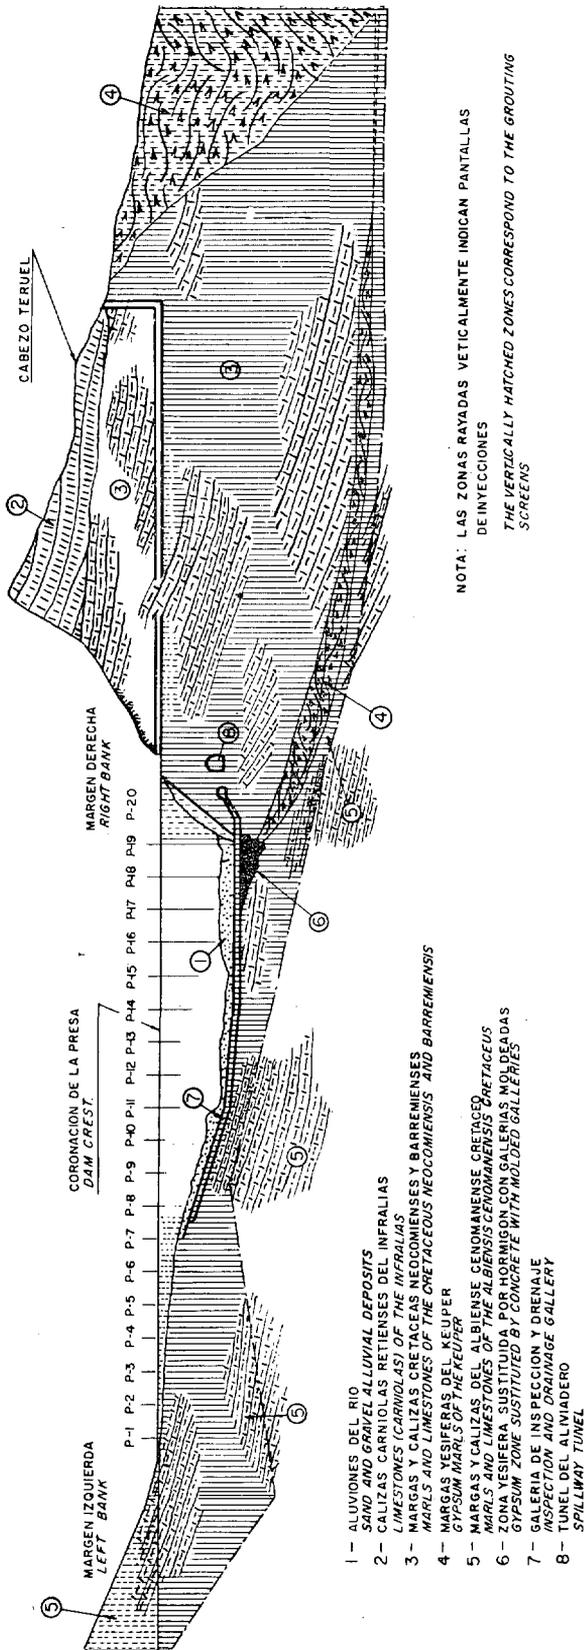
^a — Perfil geológico a lo largo de la presa con pantallas de inyecciones, zona de yesos sustituida por hormigón y otros detalles superpuestos. (Geological profile along the dam with grouting screens, gypsum zones substituted by concrete and other details superimposed).
